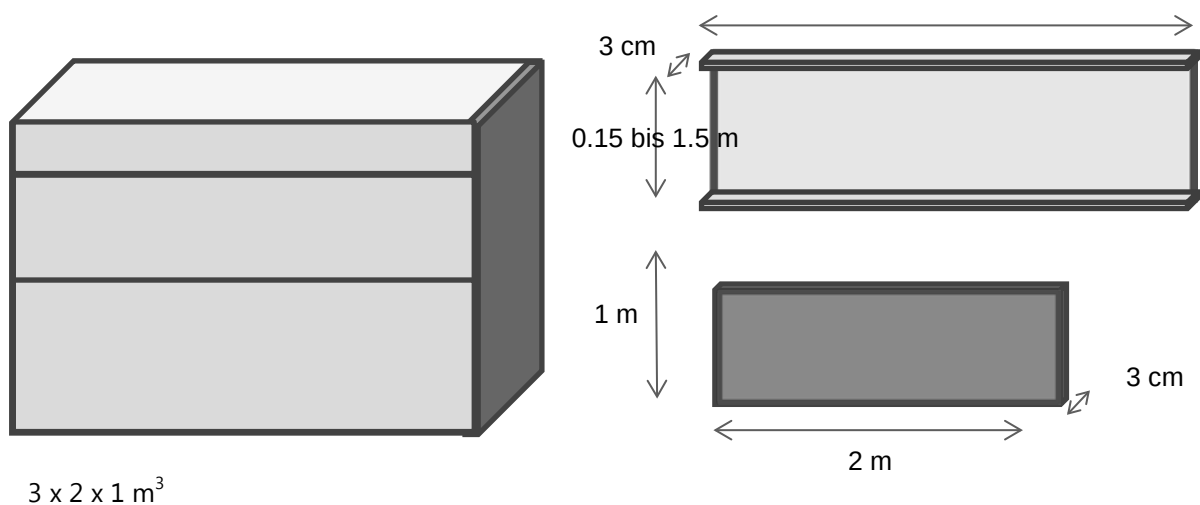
Modular zusammenbaubare Blechelemente für die dampfdichte, stabile Innenhülle.
